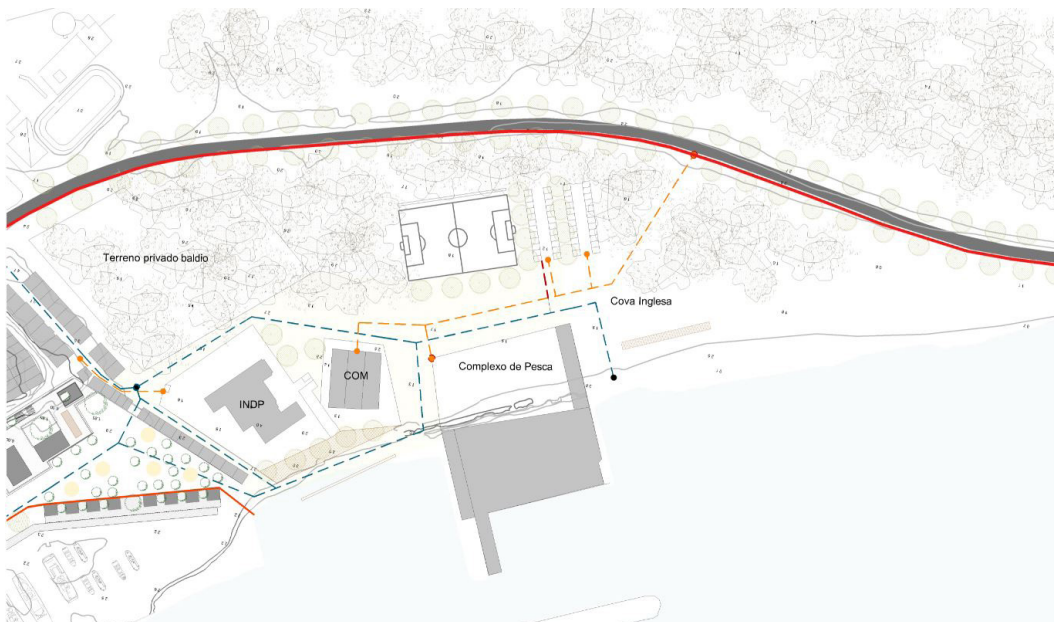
Planta da intervenção de requalificação da Cova Inglesa e área envolvente.
